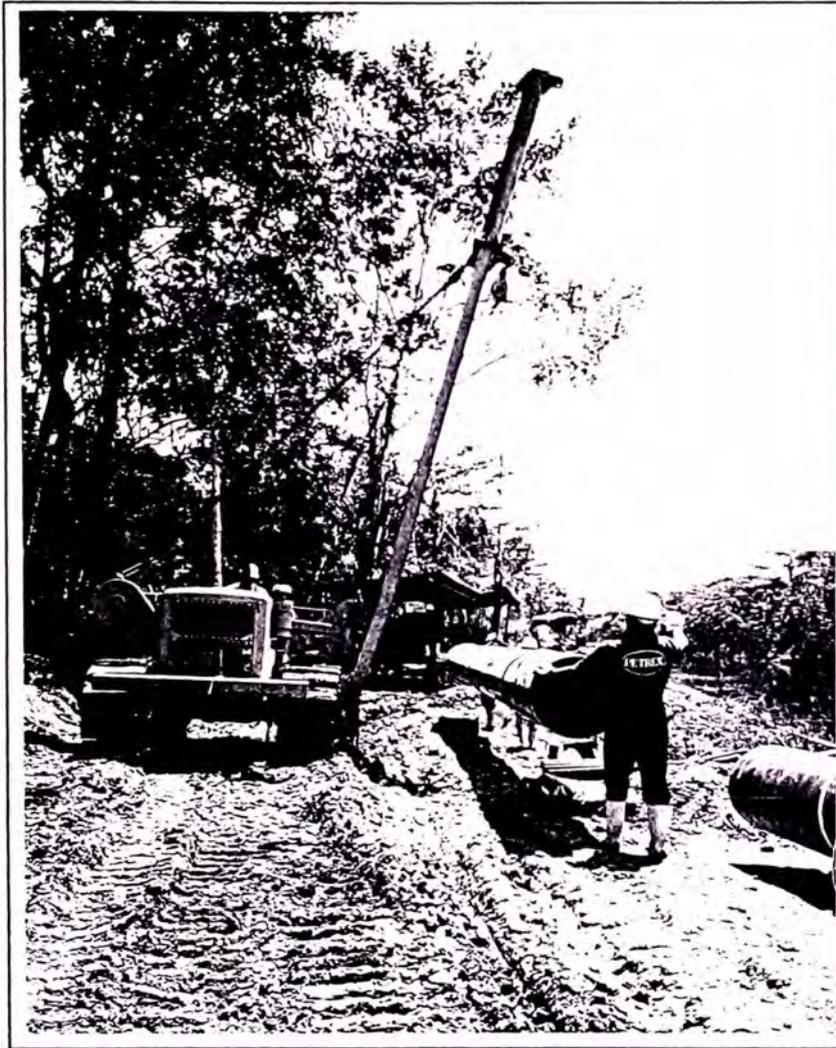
Traslado de otro tubo para alineamiento con el Side-boom.
